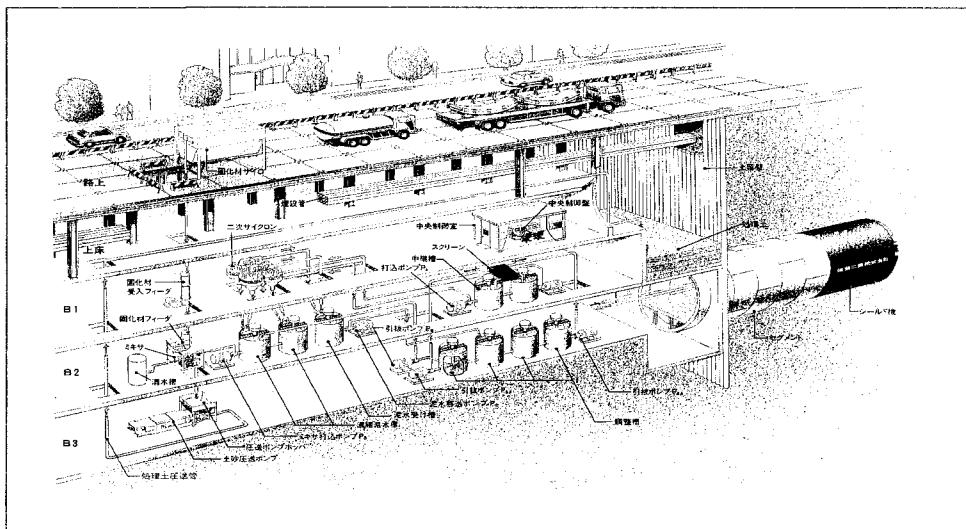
泥水処理・再利用システムによる埋戻し施工イメージ図
